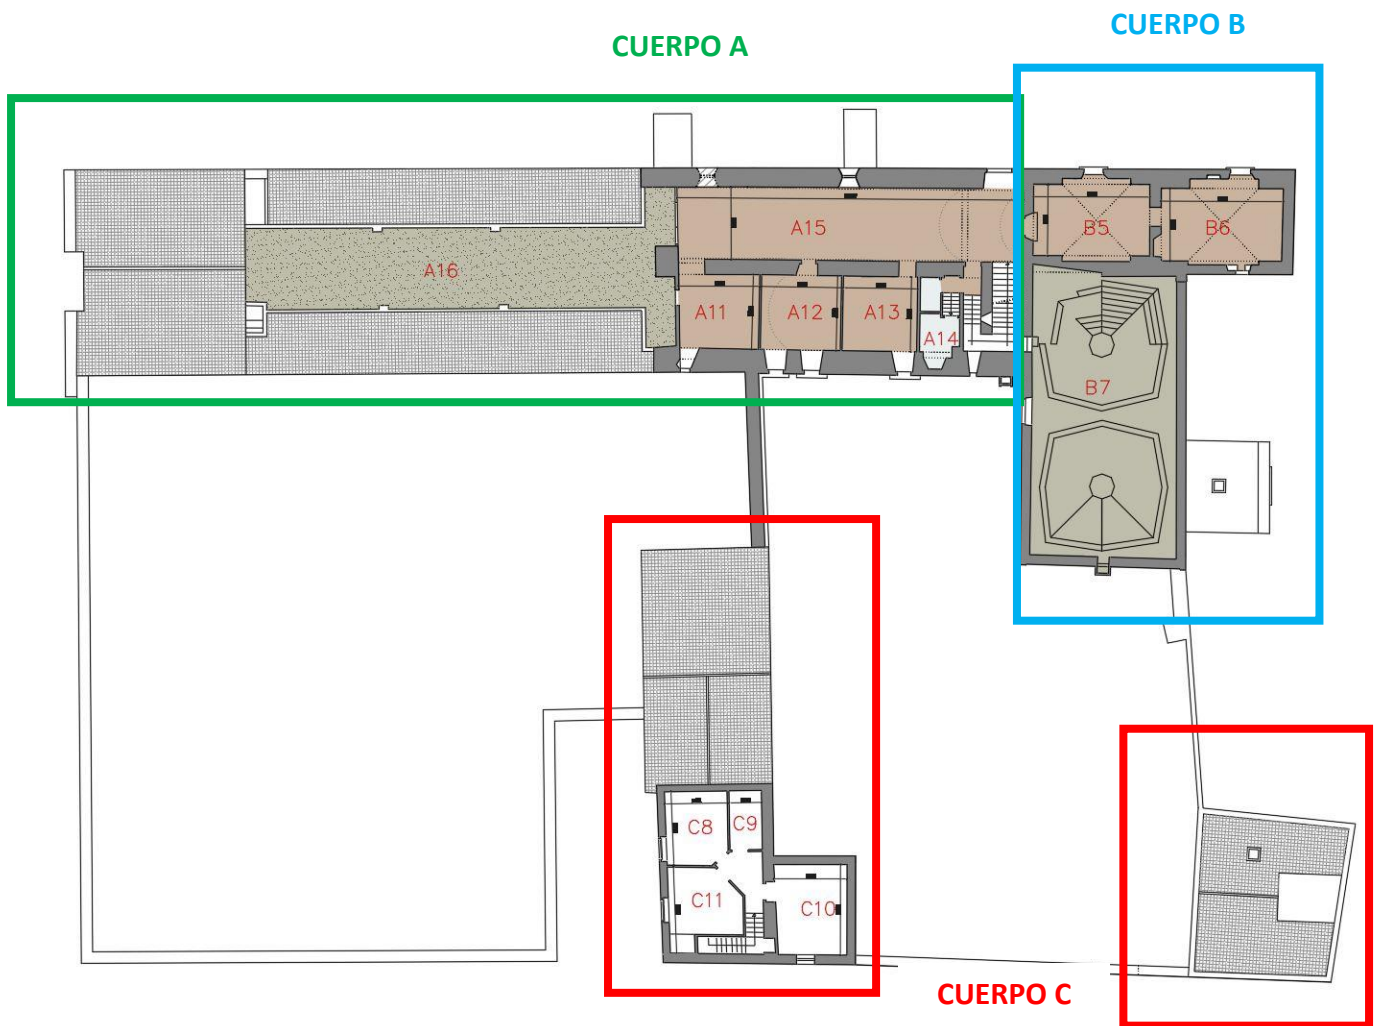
Planos De La Planta Primera Del Monasterio De Santa María De La Justicia
